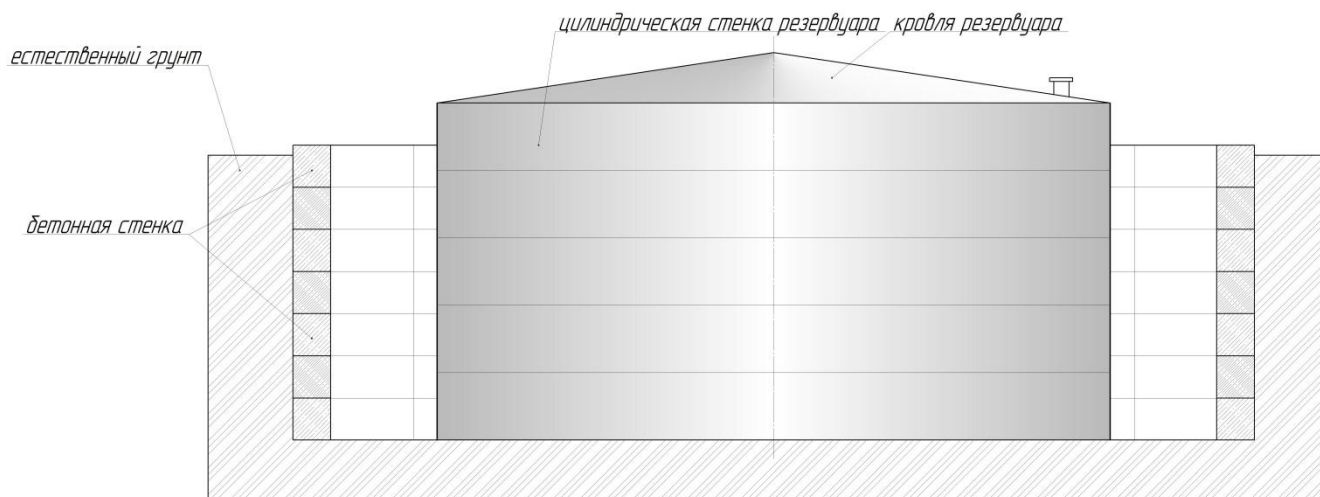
Общий вид резервуара РВС-1000 заводские номера: 8, 9, 10, 11
